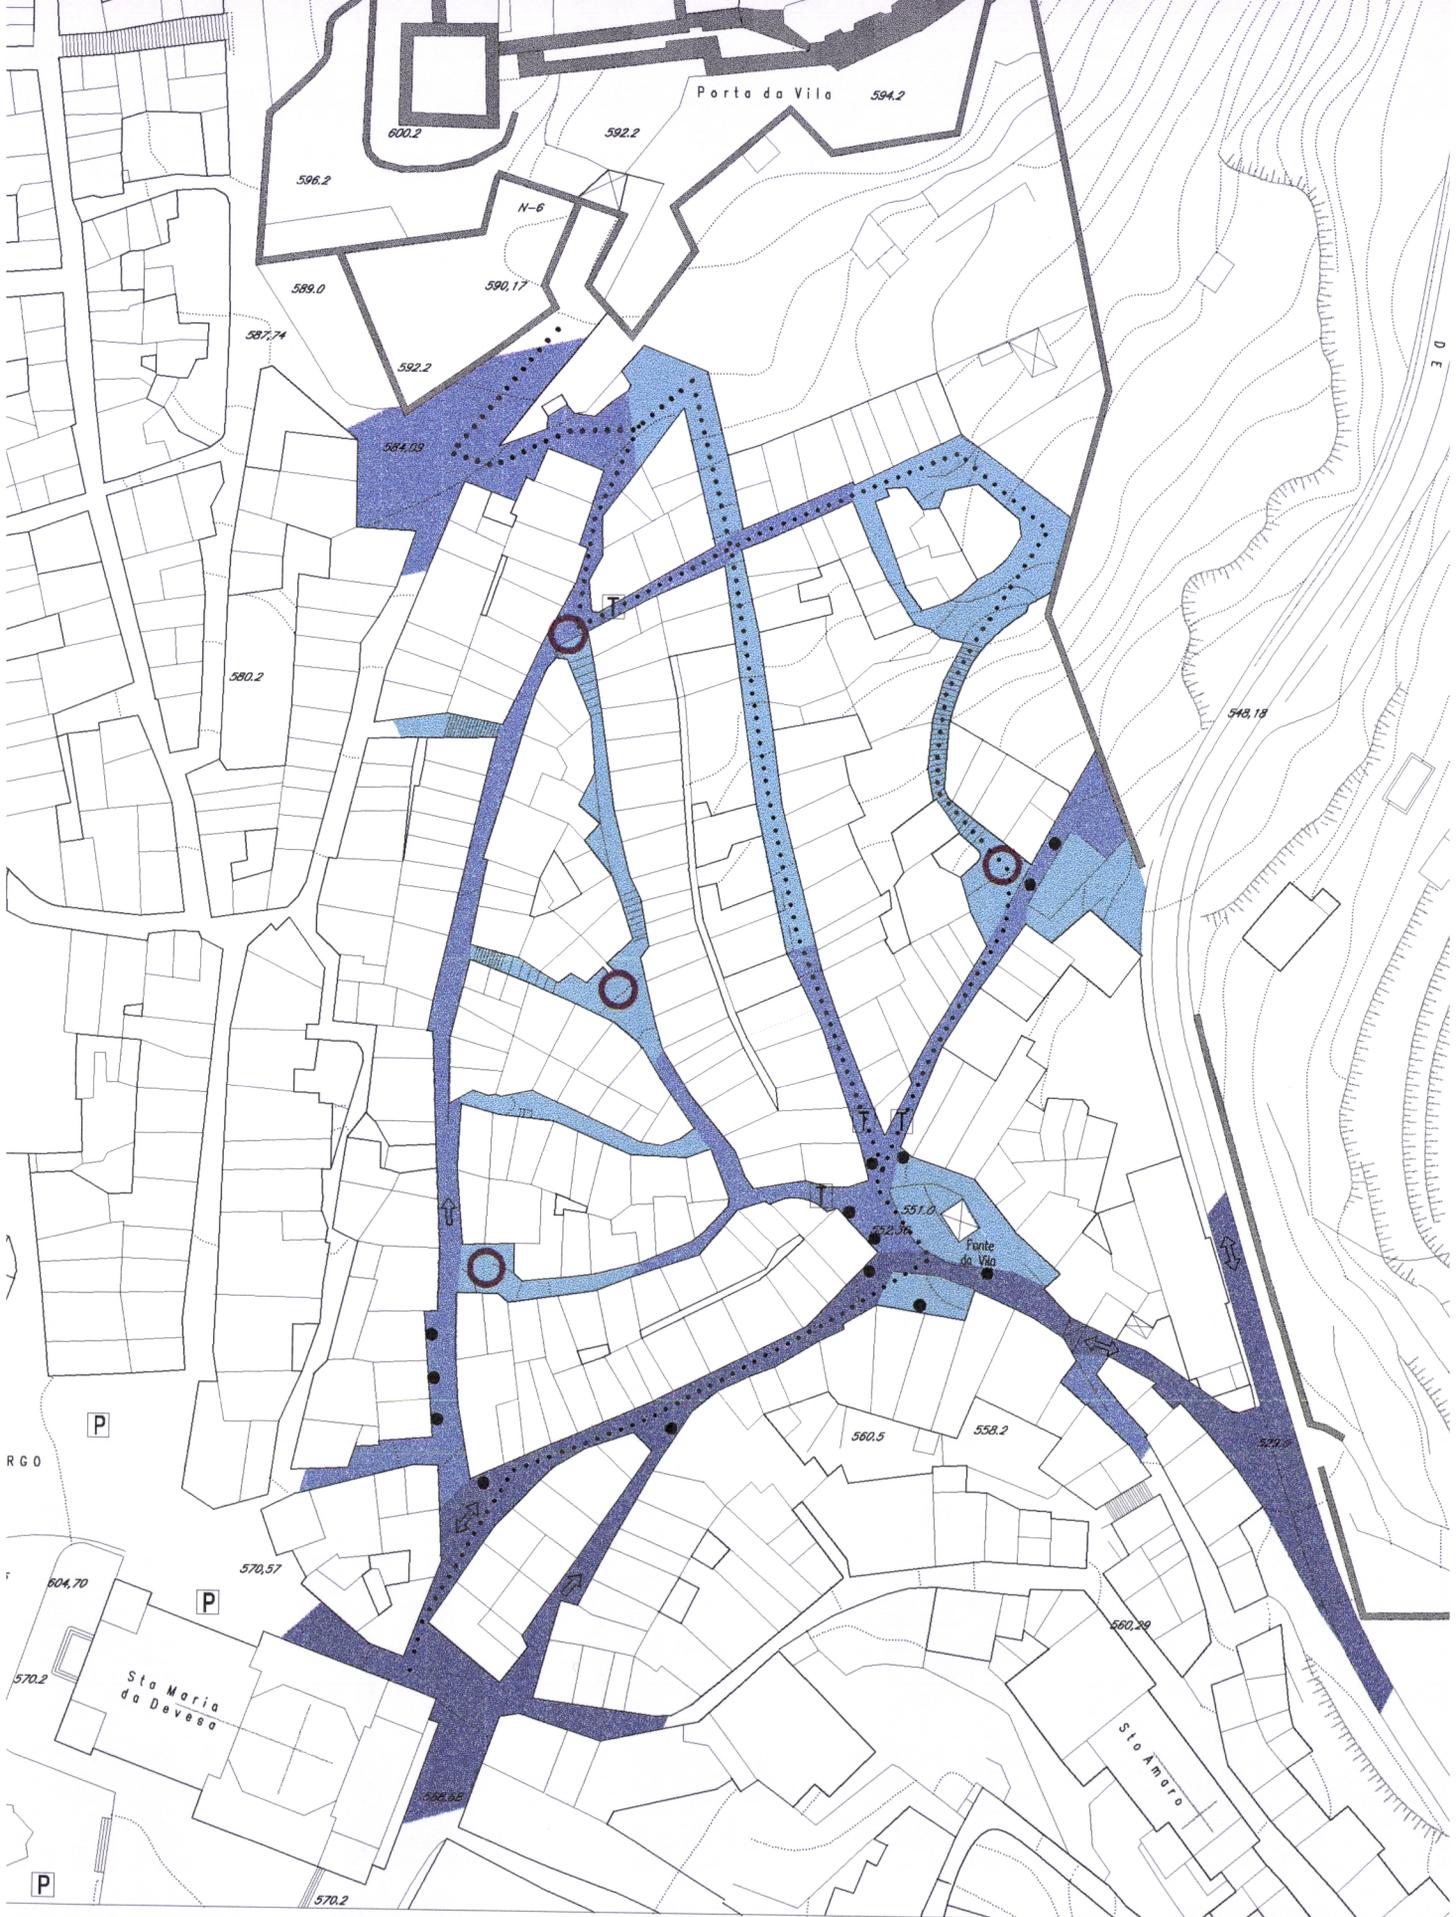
PLANTA DE CIRCULAÇÕES
